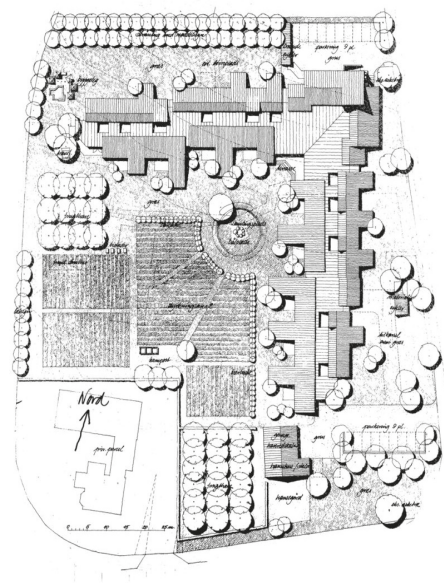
Planta - Jystrup Sawmill. Fuente: Vandkunsten (1984)
